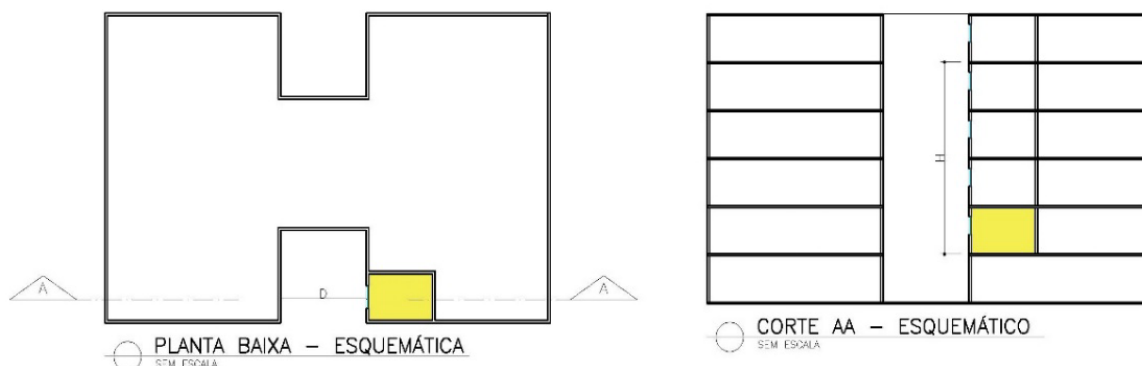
Planta baixa e corte esquemáticos AA da “área principal”, com destaque para o ambiente avaliado.
